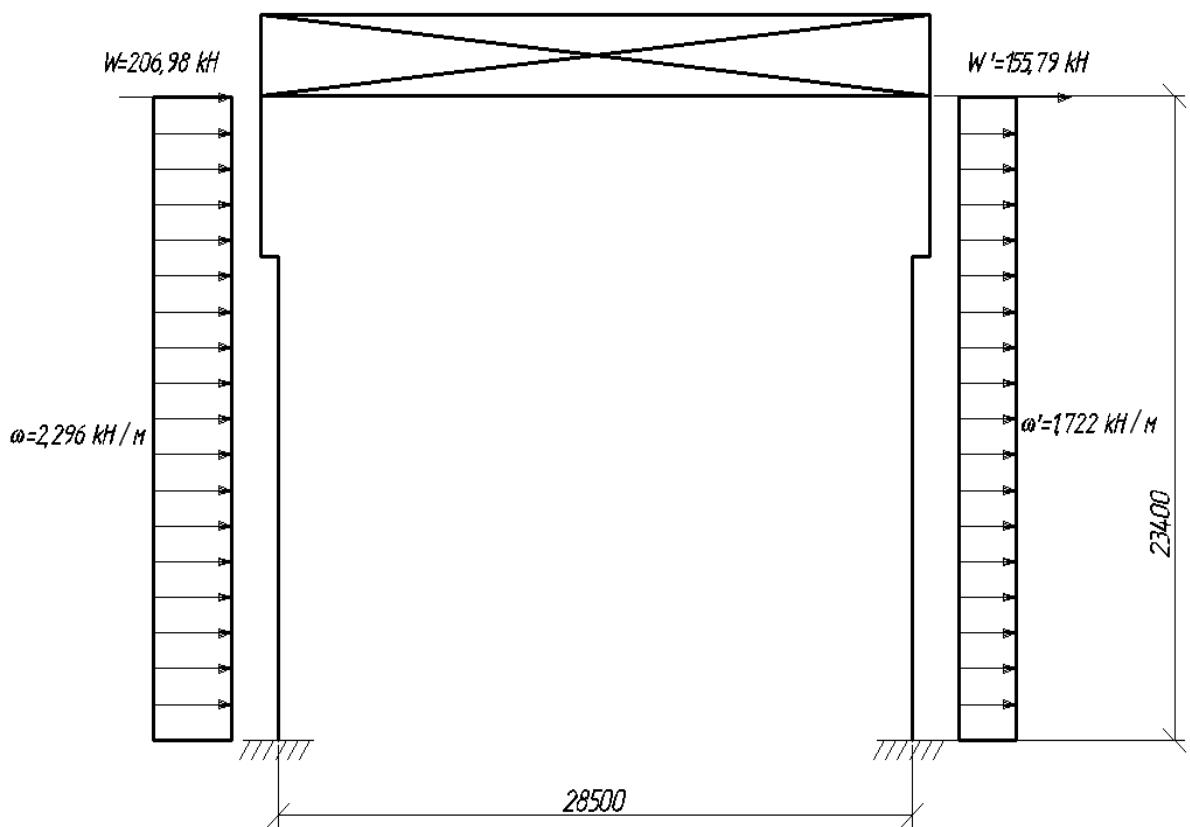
Схема вітрового навантаження за розрахунком
